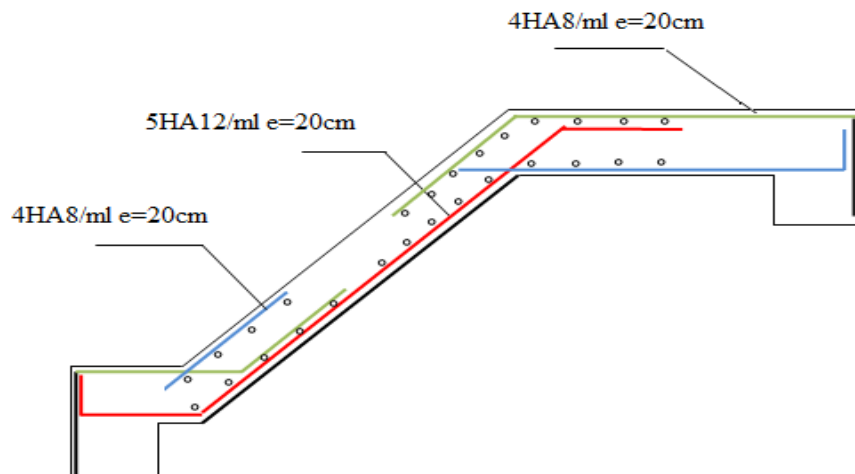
Schéma de ferrailage de l'escalier d'étages d'habitation
